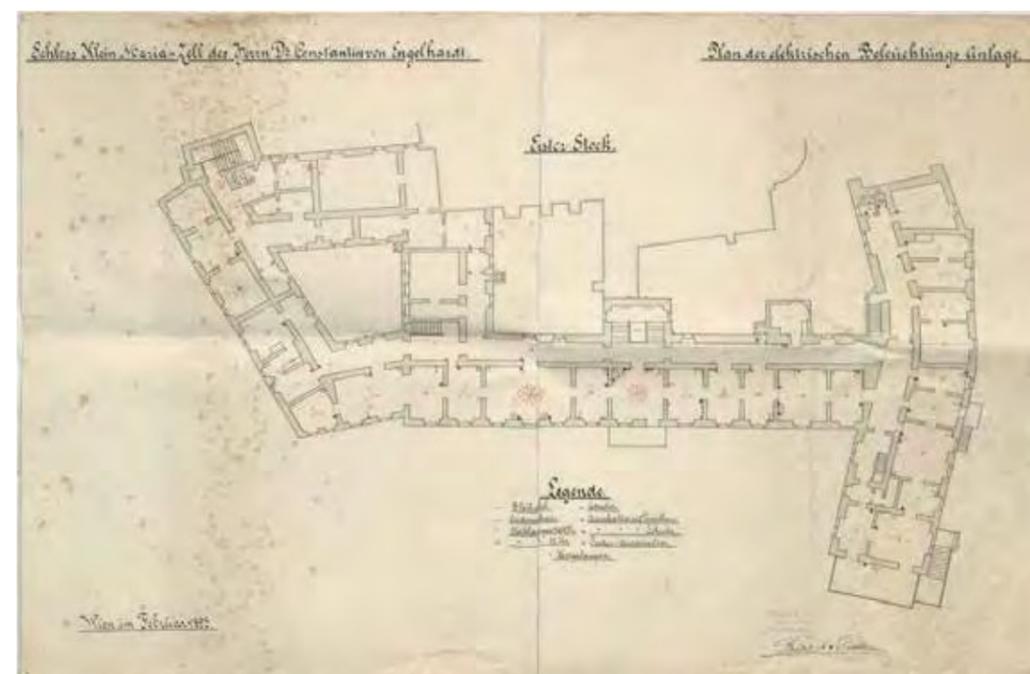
Plan zur Elektrifizierung des Schlosstraktes unter Engelhardt, 1894.
